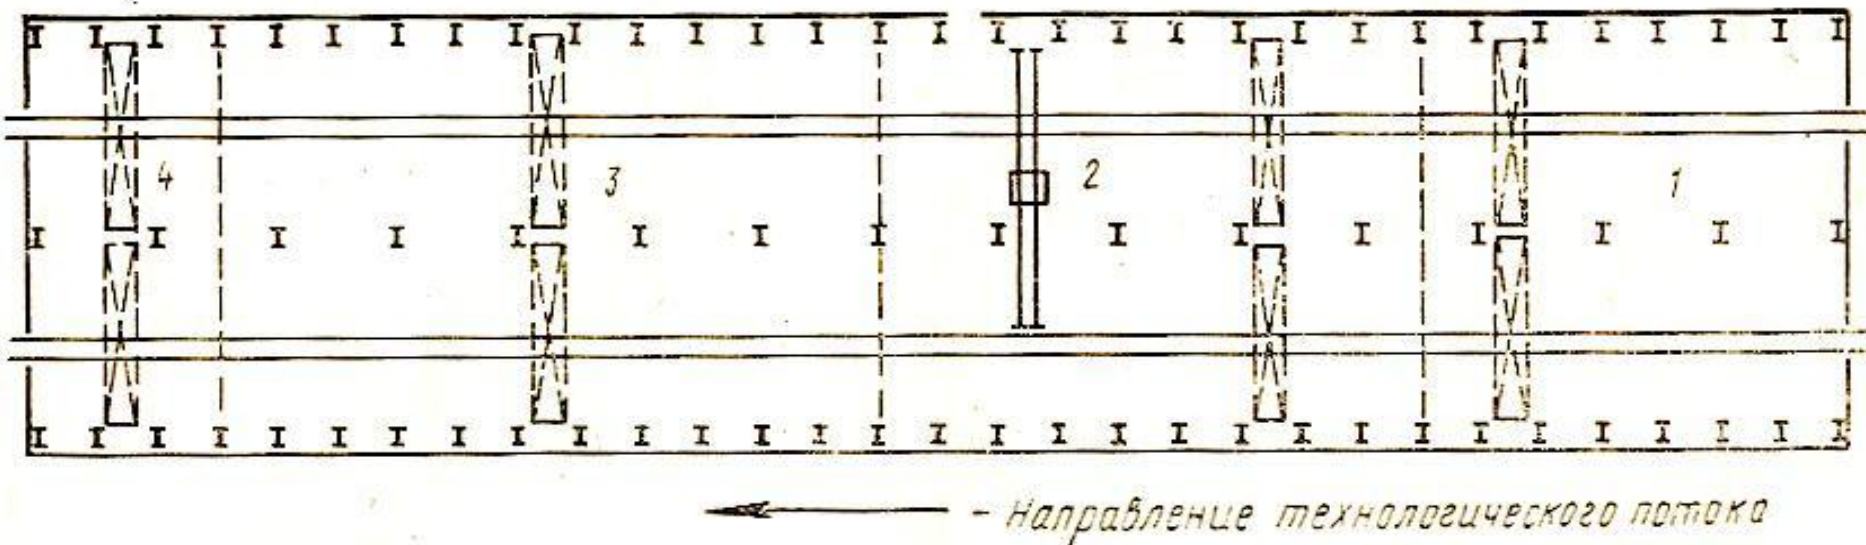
Транспортно-технологическая схема завода с продольным расположением пролетов: 1 - цех подготовки со склада металла; 2 - цех обработки со складом полуфабриката; 3 - цех сборно-сварочный; 4 - цех малярно-погрузочный
